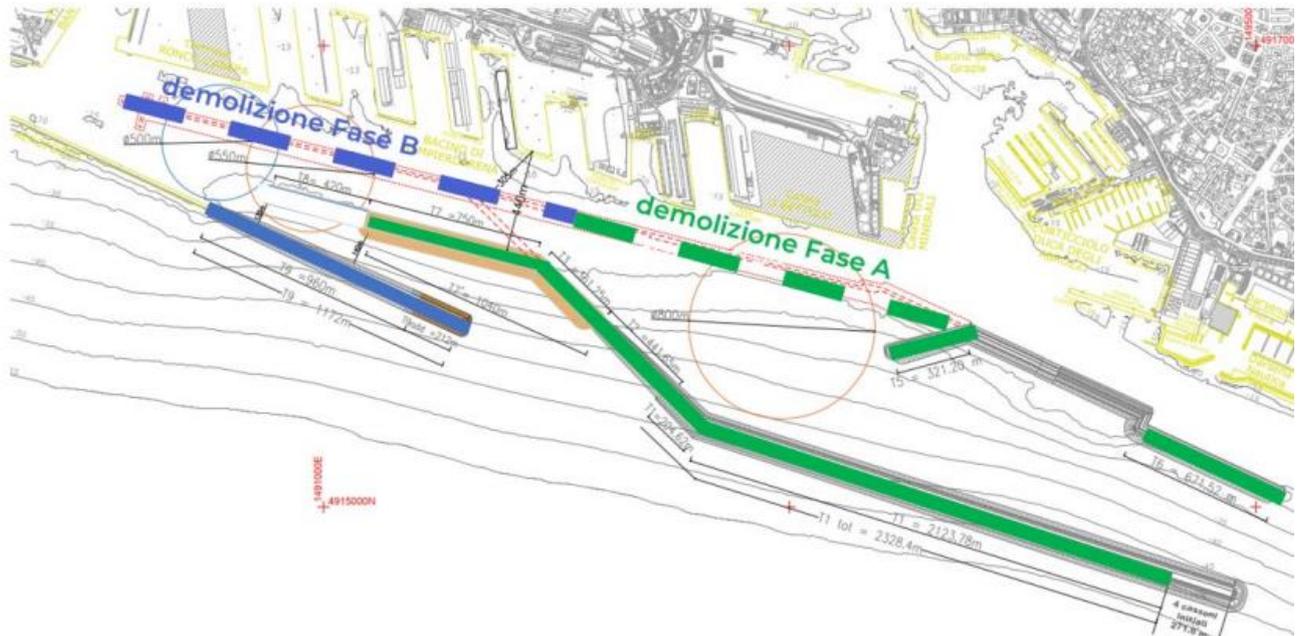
Planimetria di progetto - In verde le aree interessate dalle attività previste nella Fase A e in blu quelle previste per la Fase B
